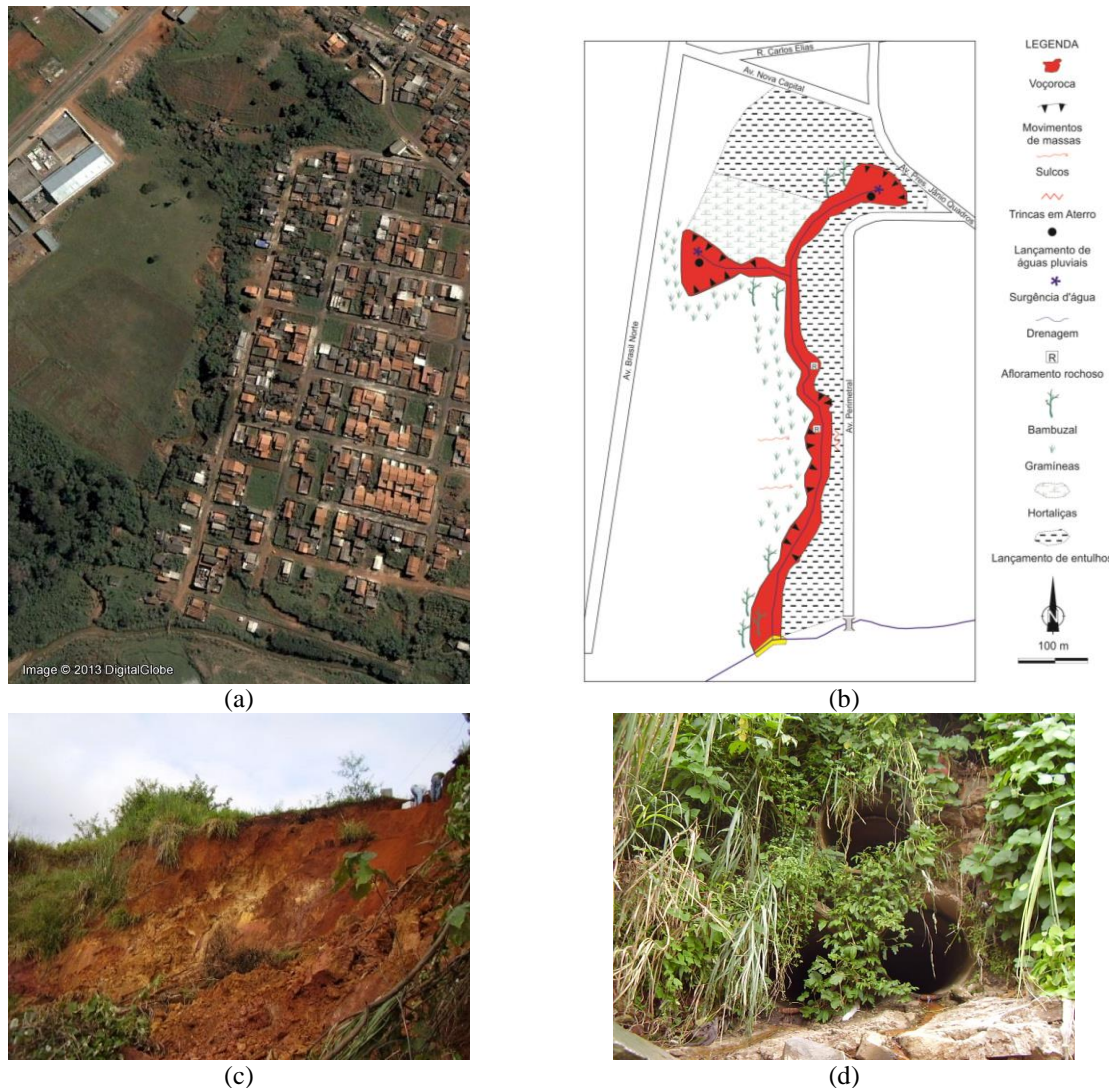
Voçoroca Cidade Jardim: (a) Vista em planta (Google Earth, 2003); (b) Croqui que demonstra as dimensões da erosão (Jesus & Santos, 2002 - modificado); (c) Movimento de massa no talude da margem direita da ramificação esquerda; (d) Tubulação de lançamento de águas pluviais na cabeceira da ramificação esquerda.
